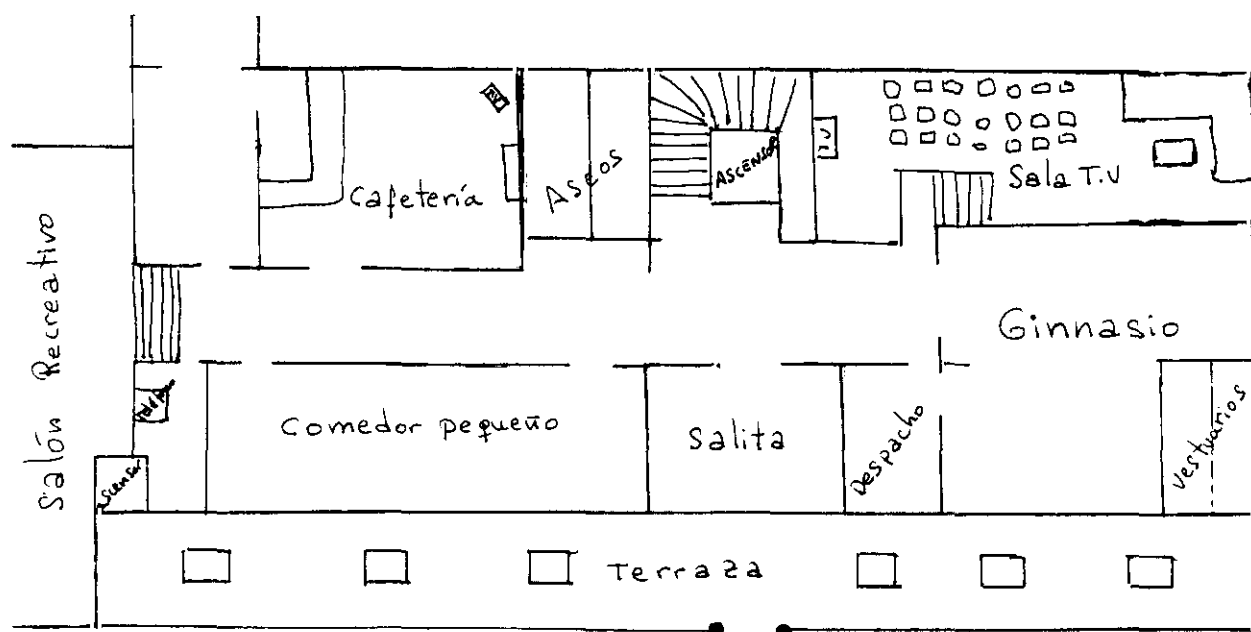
Plano planta primera del Hotel Termas. (B. Termas Pallarés).
